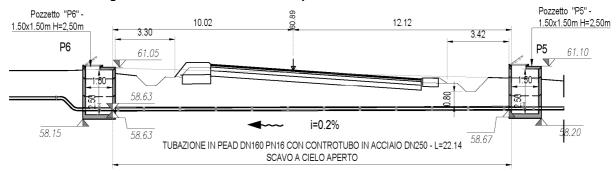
Attraversamento NV03 pk 0+160.698 - Sezione Trasversale
